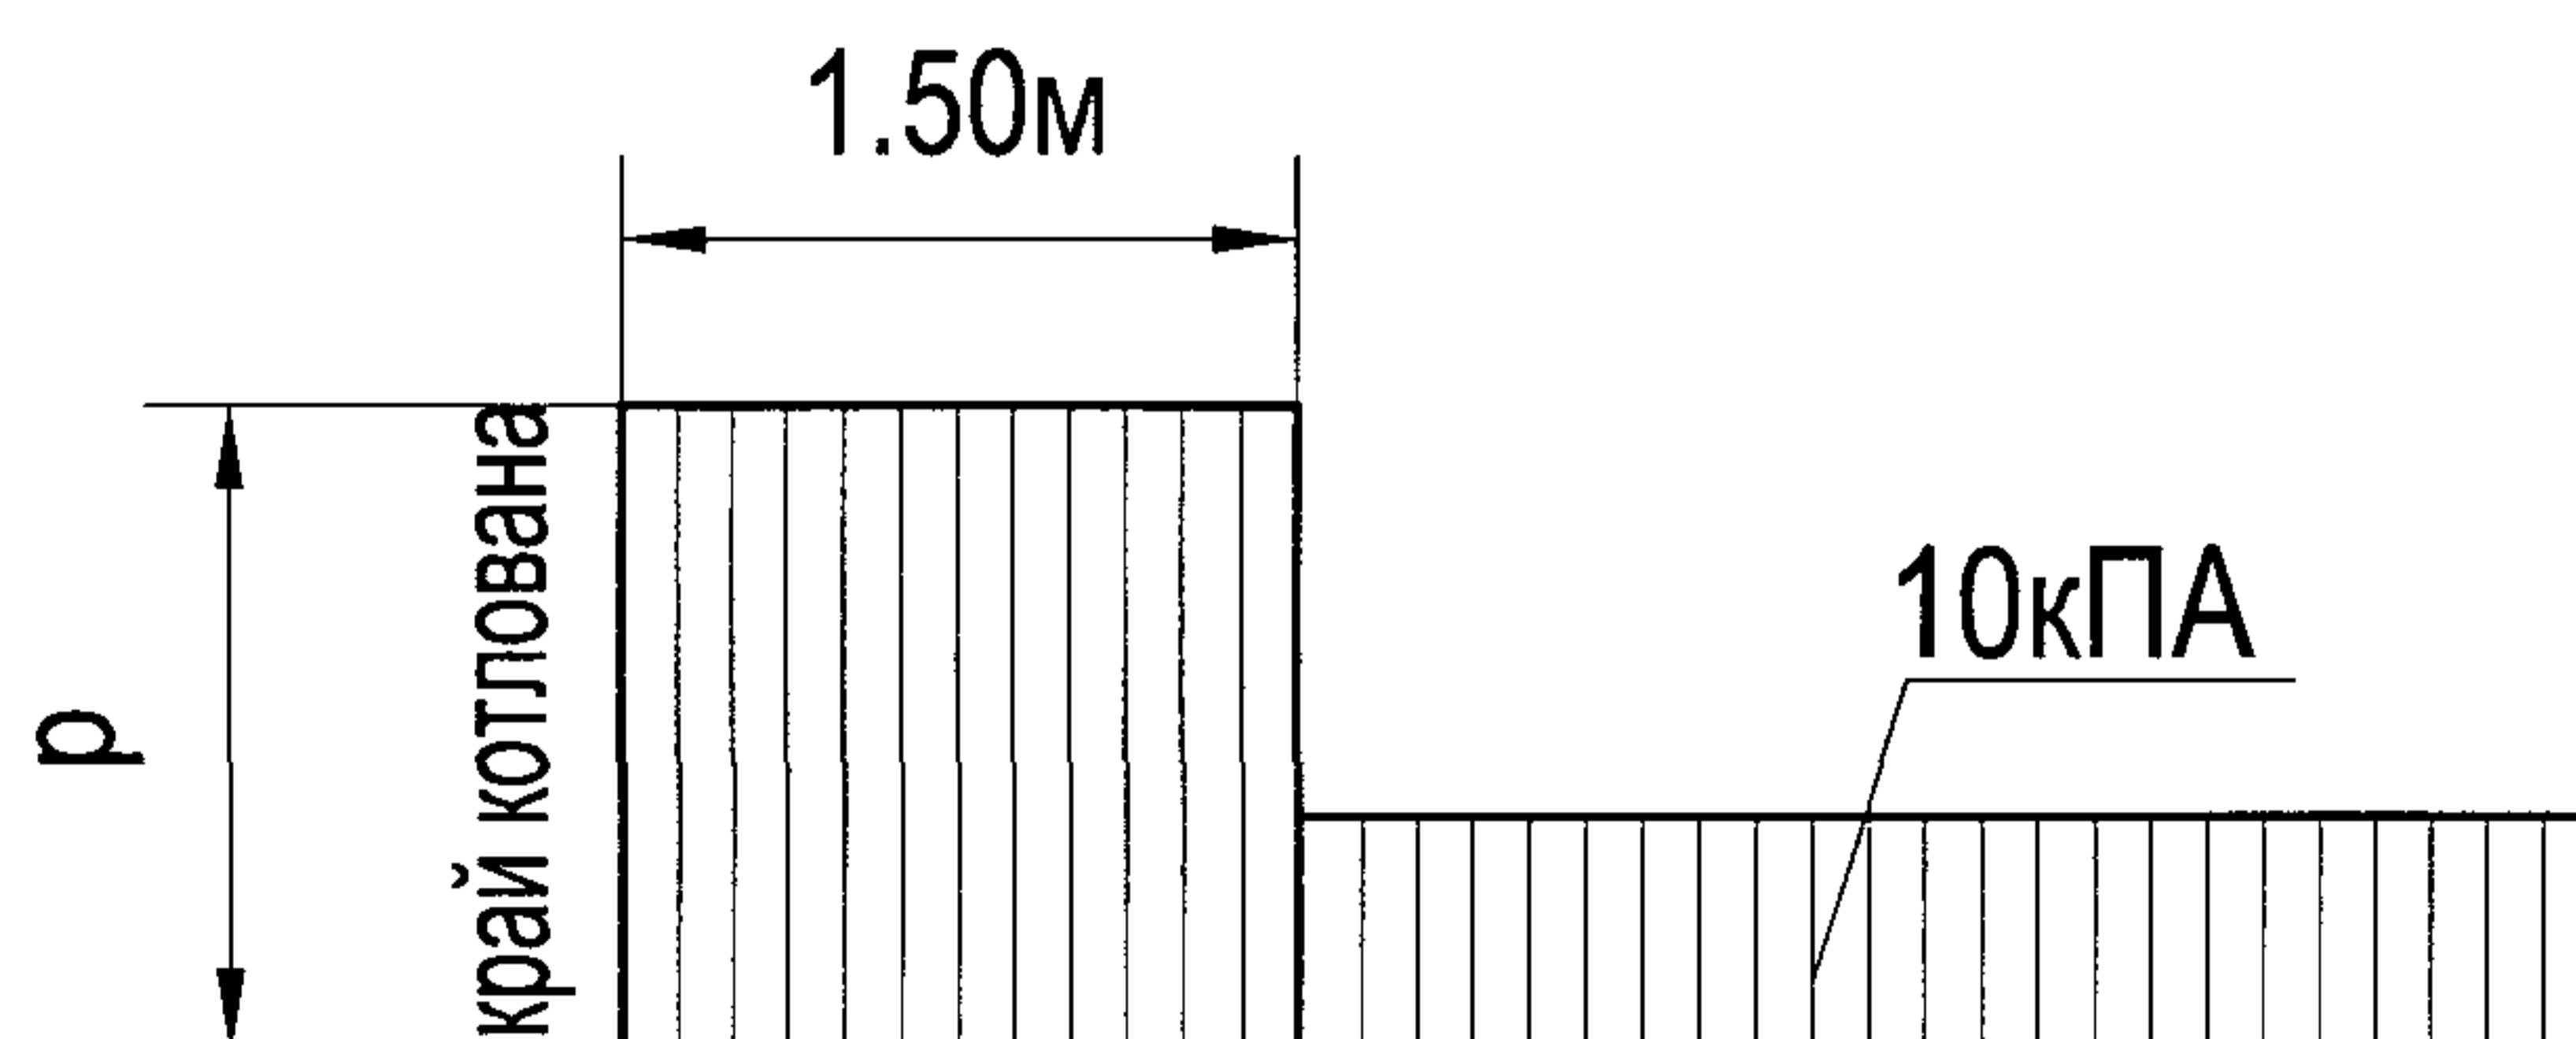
Вертикальная нагрузка на призме обрушения от гусеничных и колесных кранов
